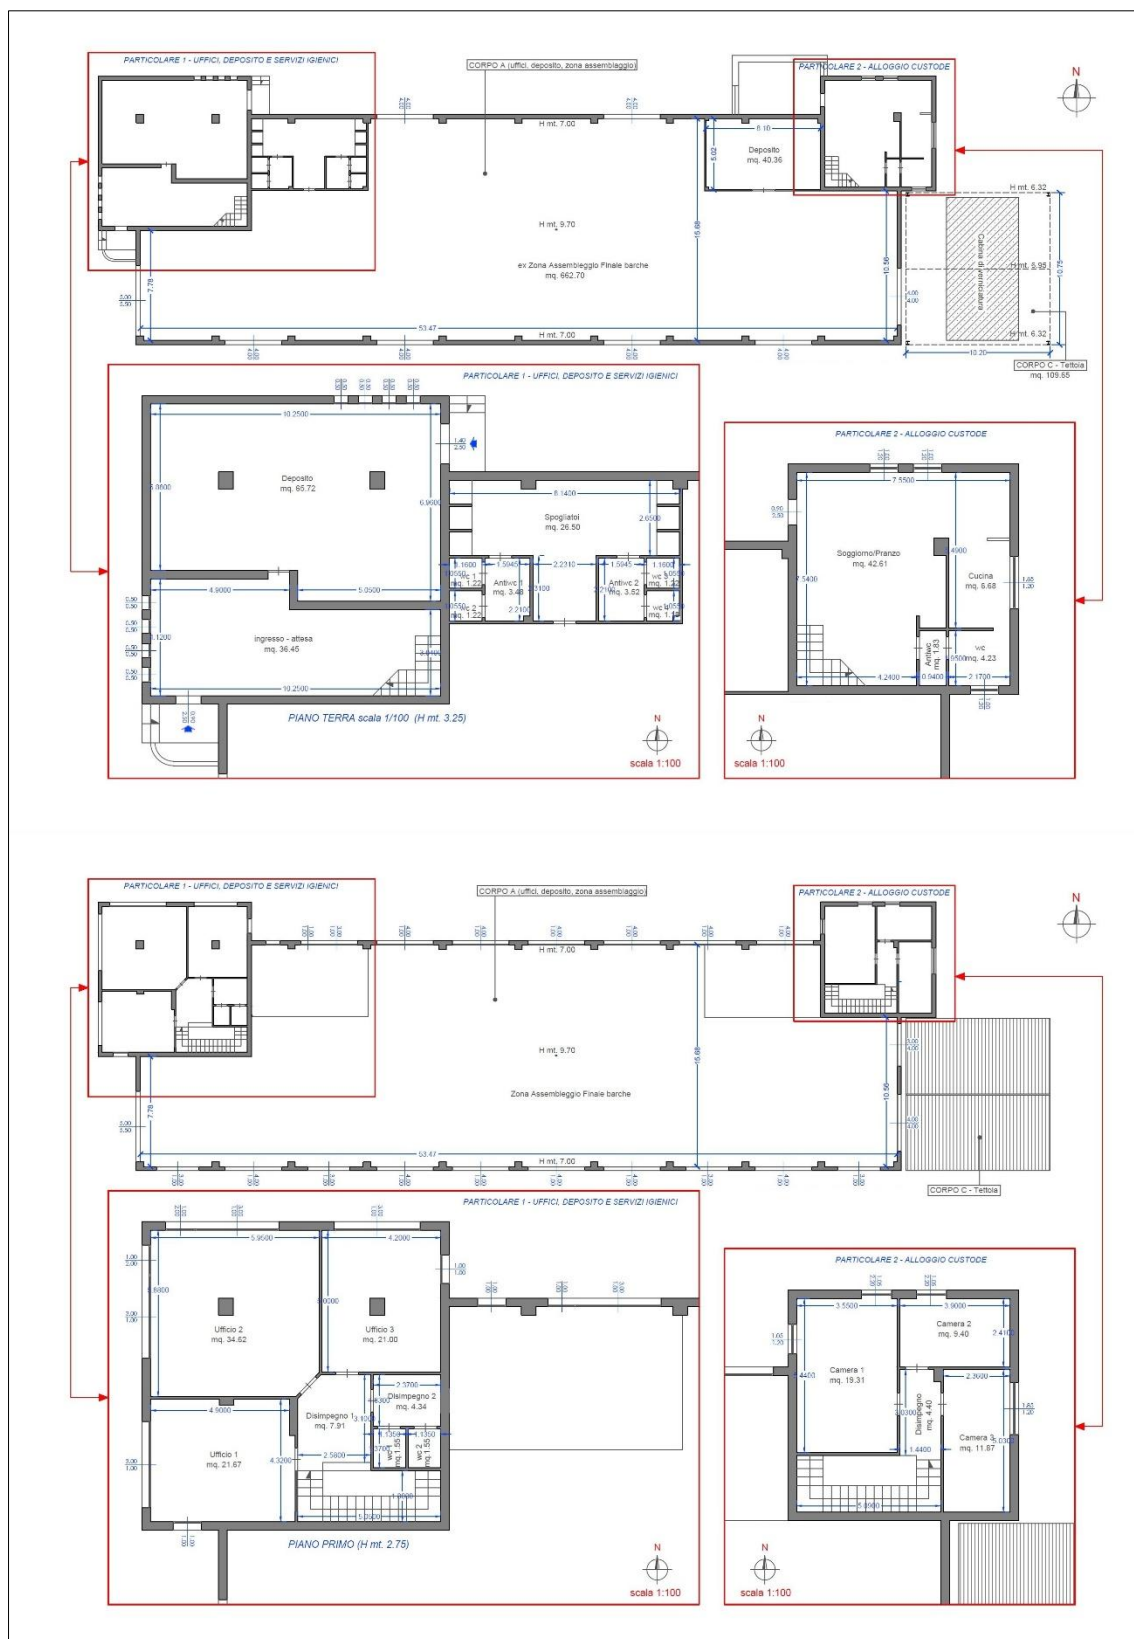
Stato di fatto: planimetria piano terra e piano primo.
